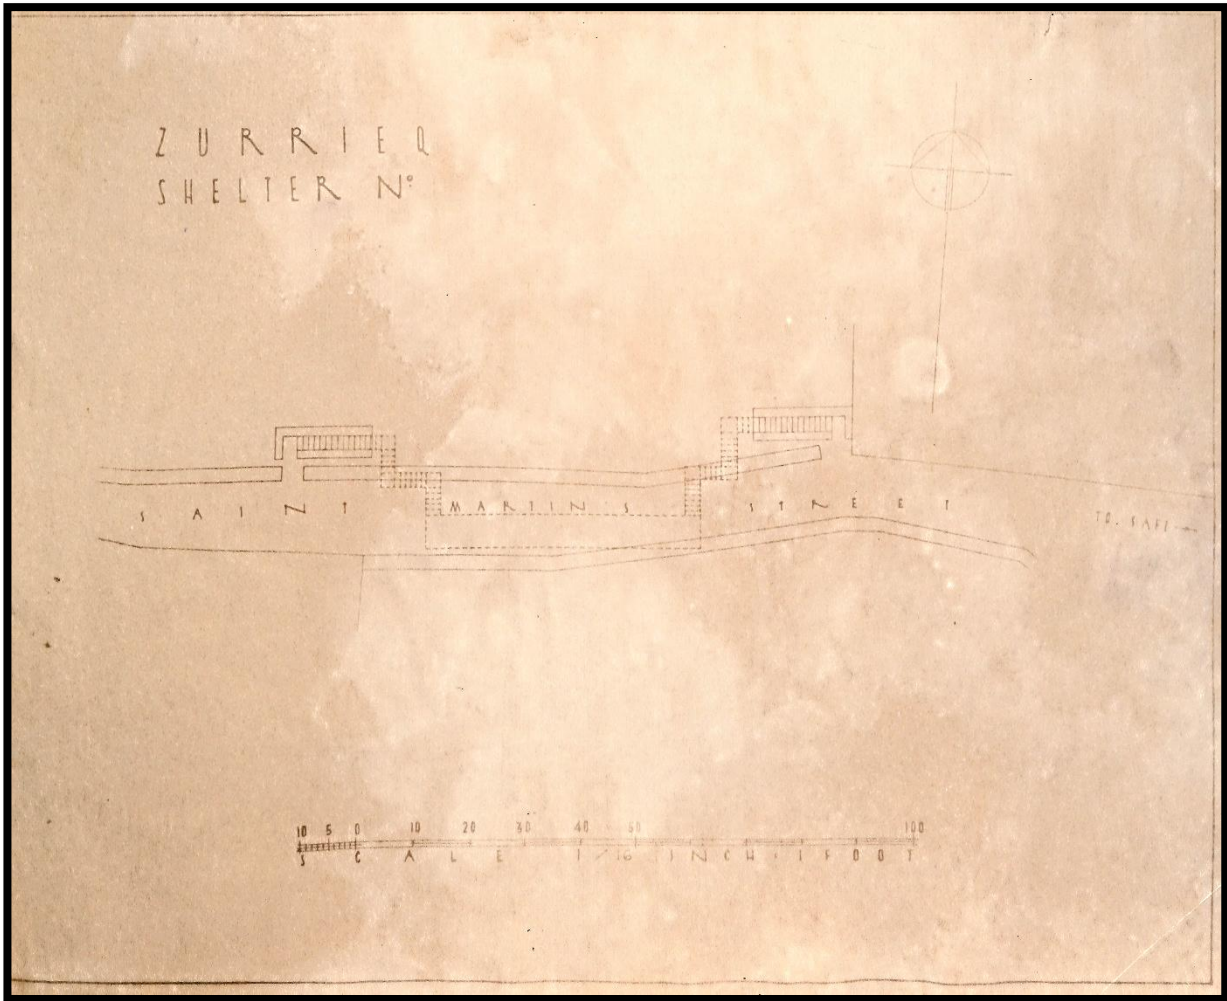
Planta do Abrigo "Saint Martin's Street – To Safi"
